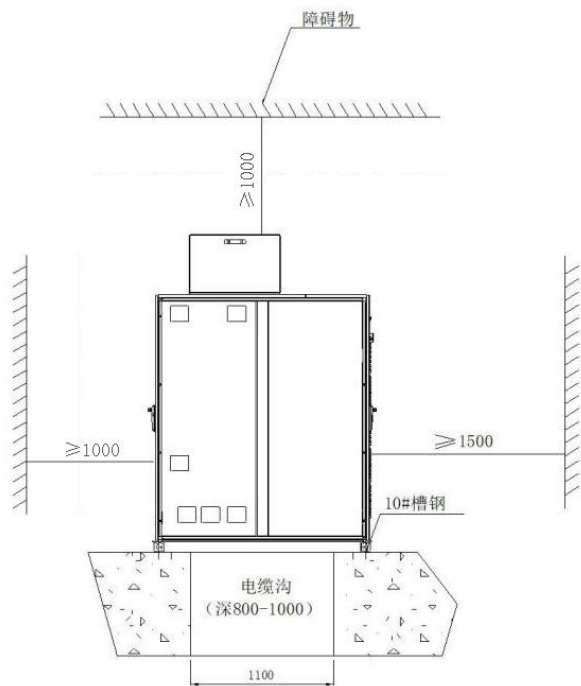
高压变频调速系统双列安装要求示意图 3（侧视图，单位：mm）
